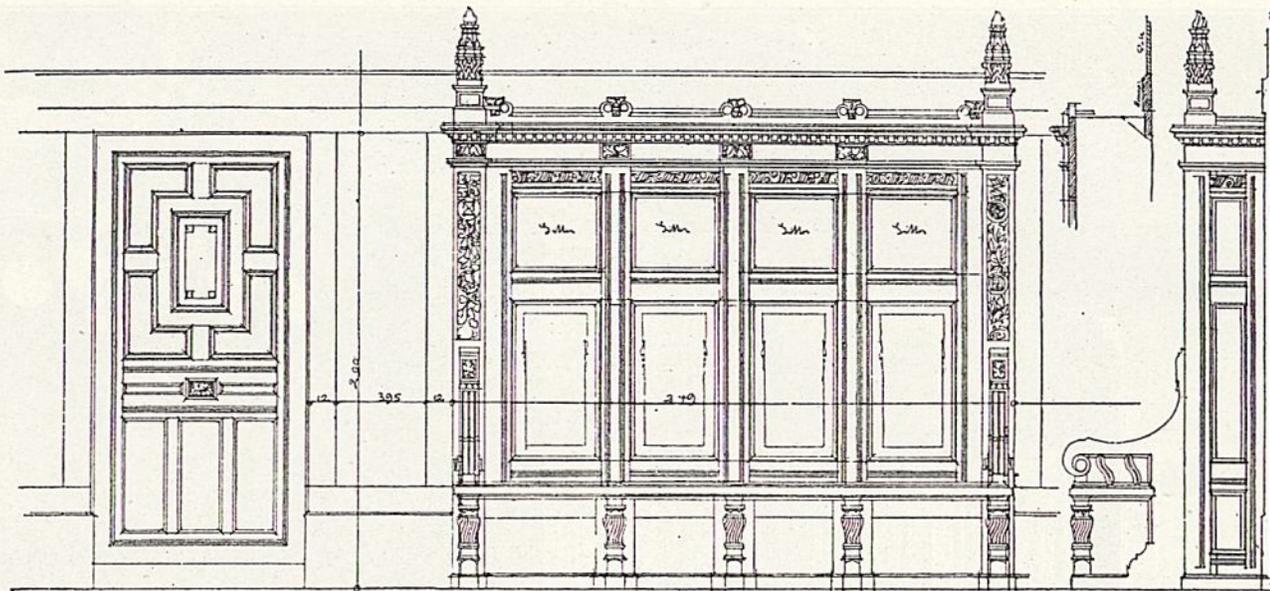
Heizkörper mit Sitzbank im Erdgeschoß des Haupttreppenflurs.
